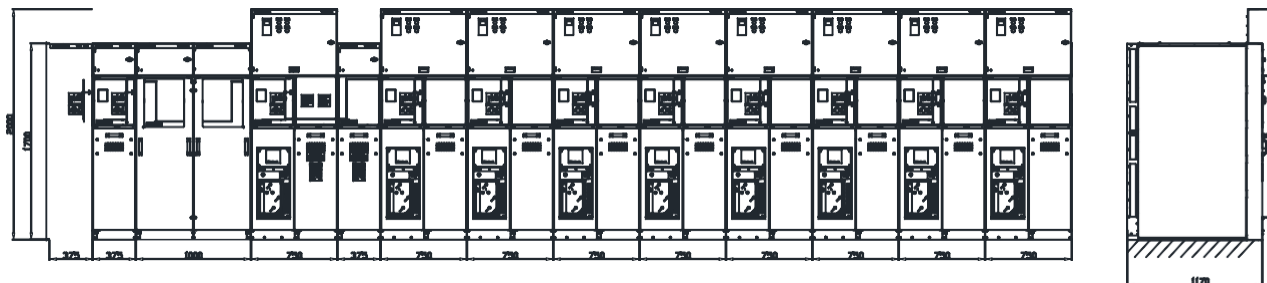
Layout orientativo – Cubículos da Subestação 01
